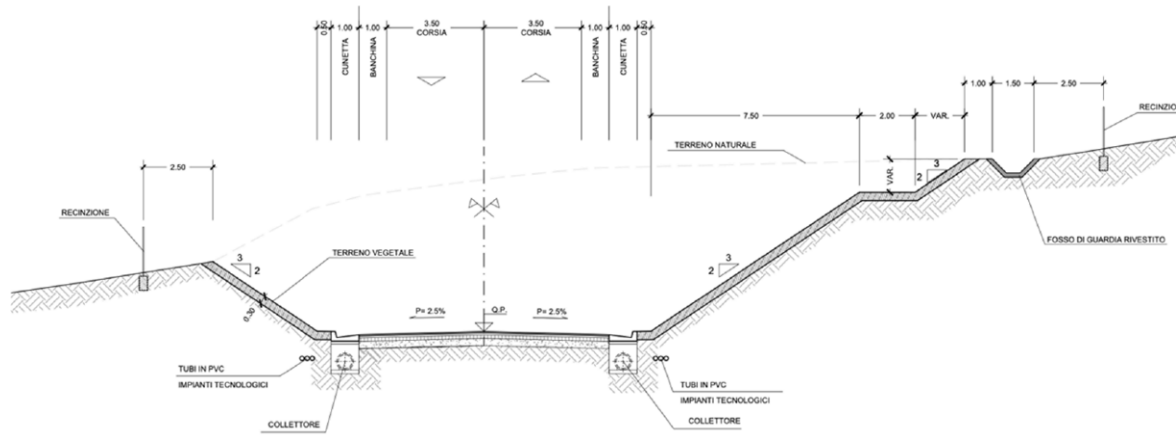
Sezione tipo in trincea per le strade tipo F1
